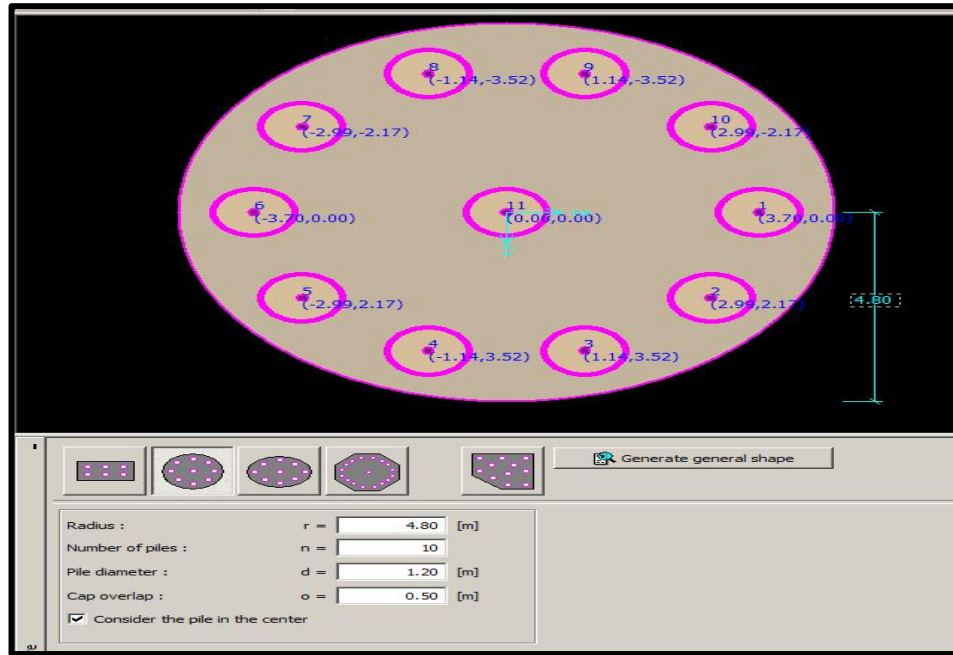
Vue en plan des pieux de la tour 7 (GEO5 pile groupe).
